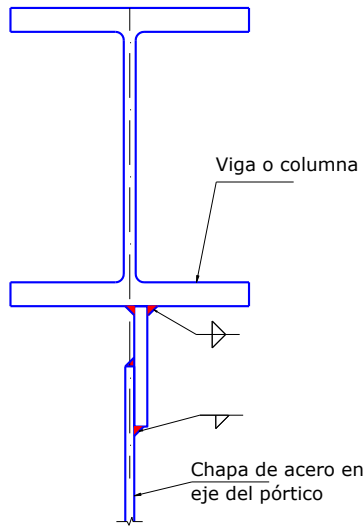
Detalle típico de conexión soldada entre los elementos de borde y la placa de alma.
